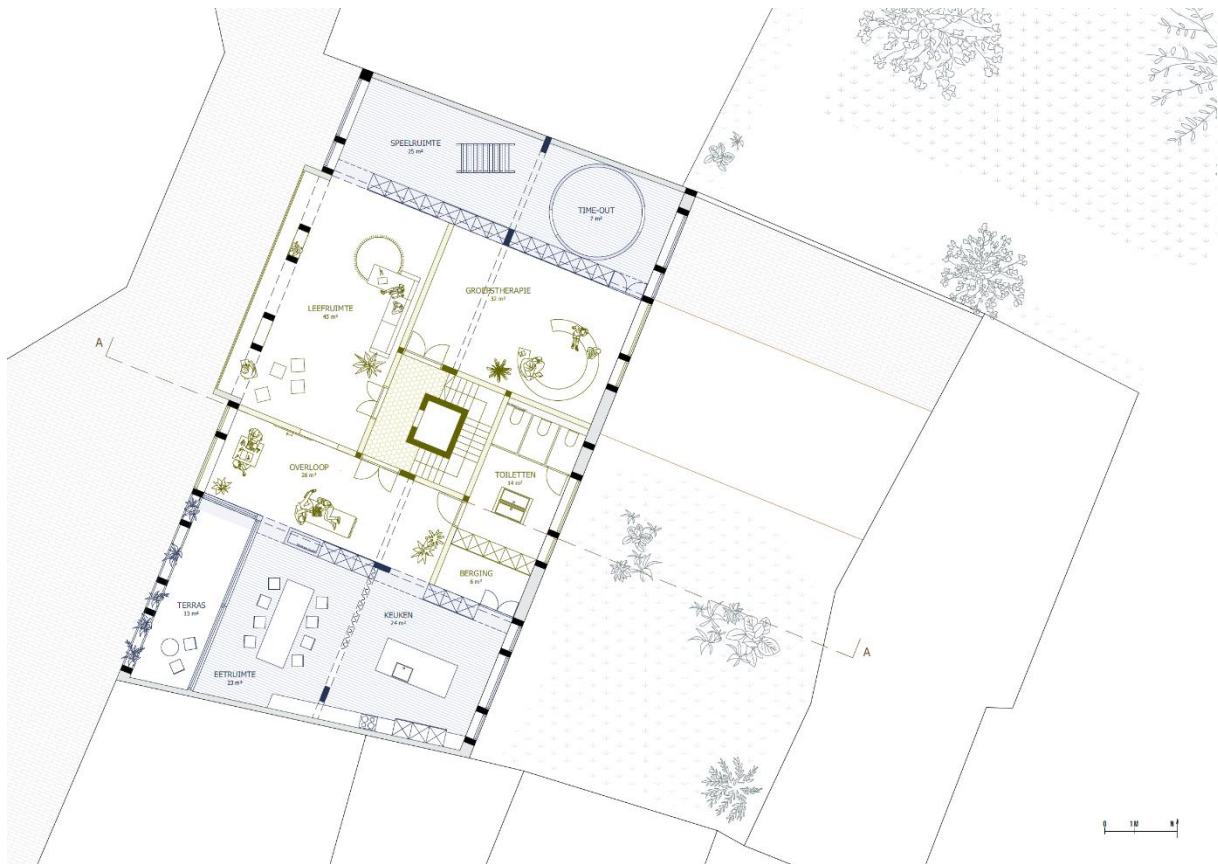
Plan gelijkvloers De Korbeel Kortrijk. (VK Architects, z.d.)
